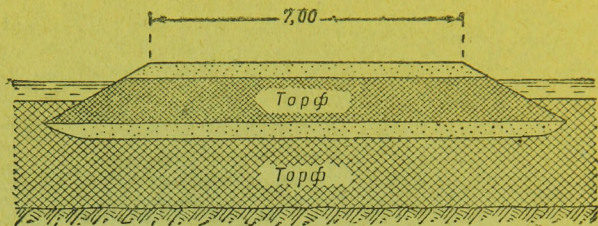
Торфяная насыпь на сплошном болоте на пойме
